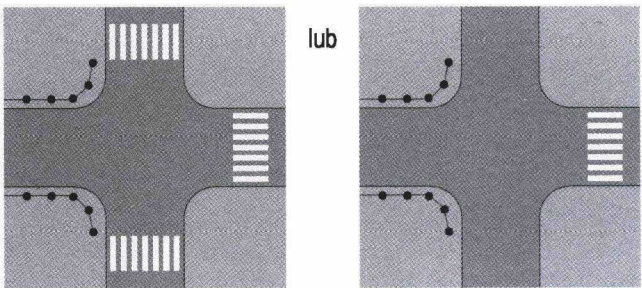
Sposób wyznaczenia przejścia dla pieszych przez powierzchnię wyłączoną z ruchu
